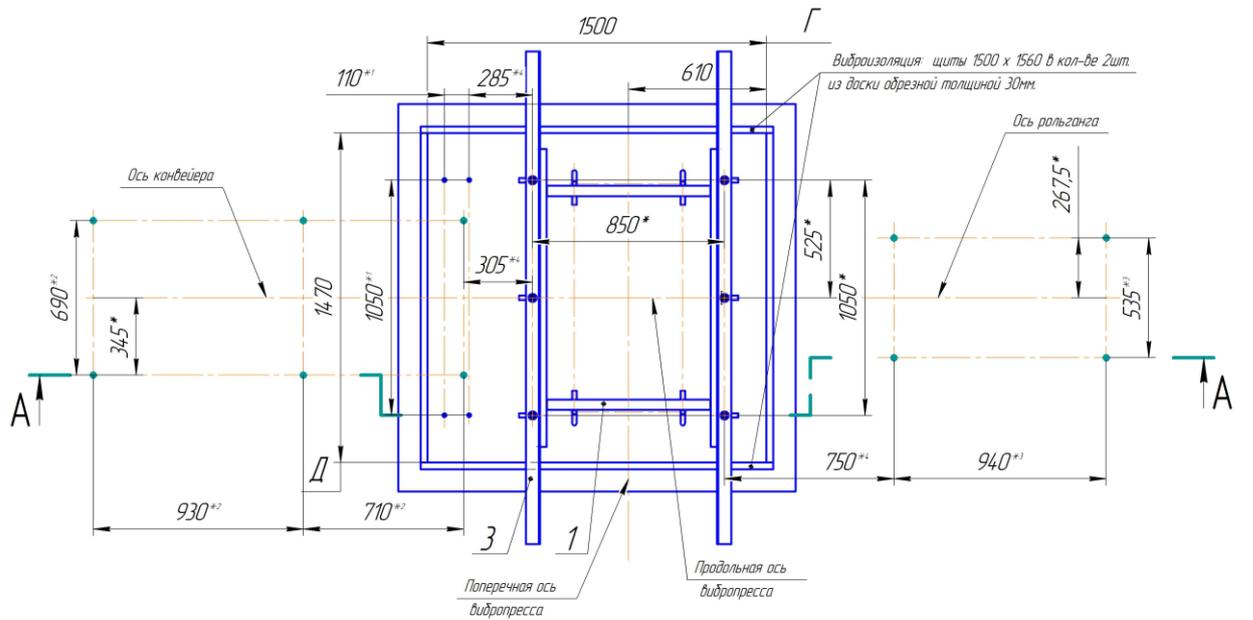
План фундамента комплекса Метеор-РЗМ
